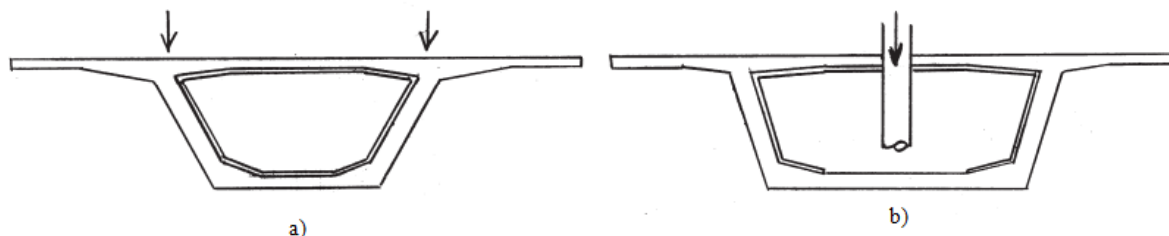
Métodos de betonagem contínua de secção em caixa: a) laje inferior estreita; b) laje inferior larga (Benaïm 2008)
